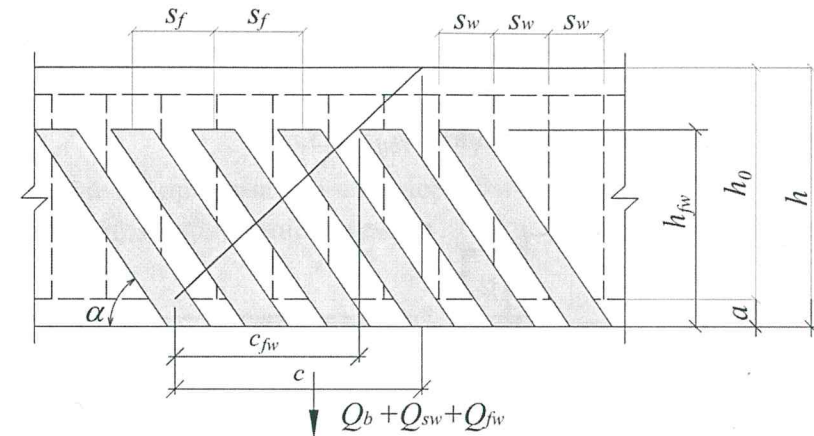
Схема усилий при расчете железобетонных элементов с внешним армированием из полимерных композитов по наклонному сечению на действие поперечных сил
